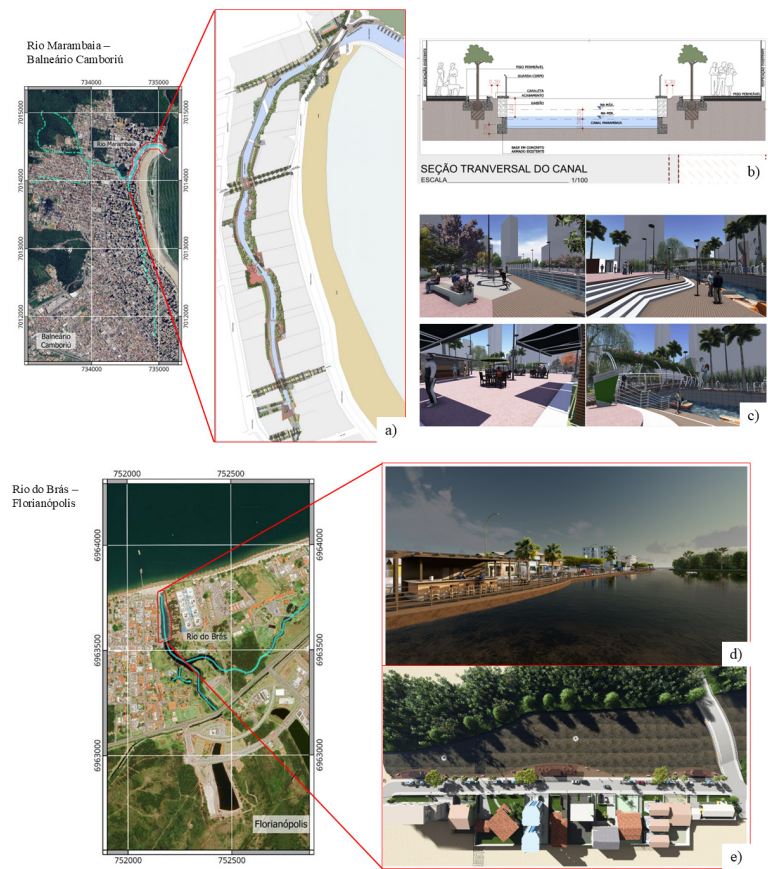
Propostas de intervenção. a) Implantação geral do projeto do rio Marambaia.
